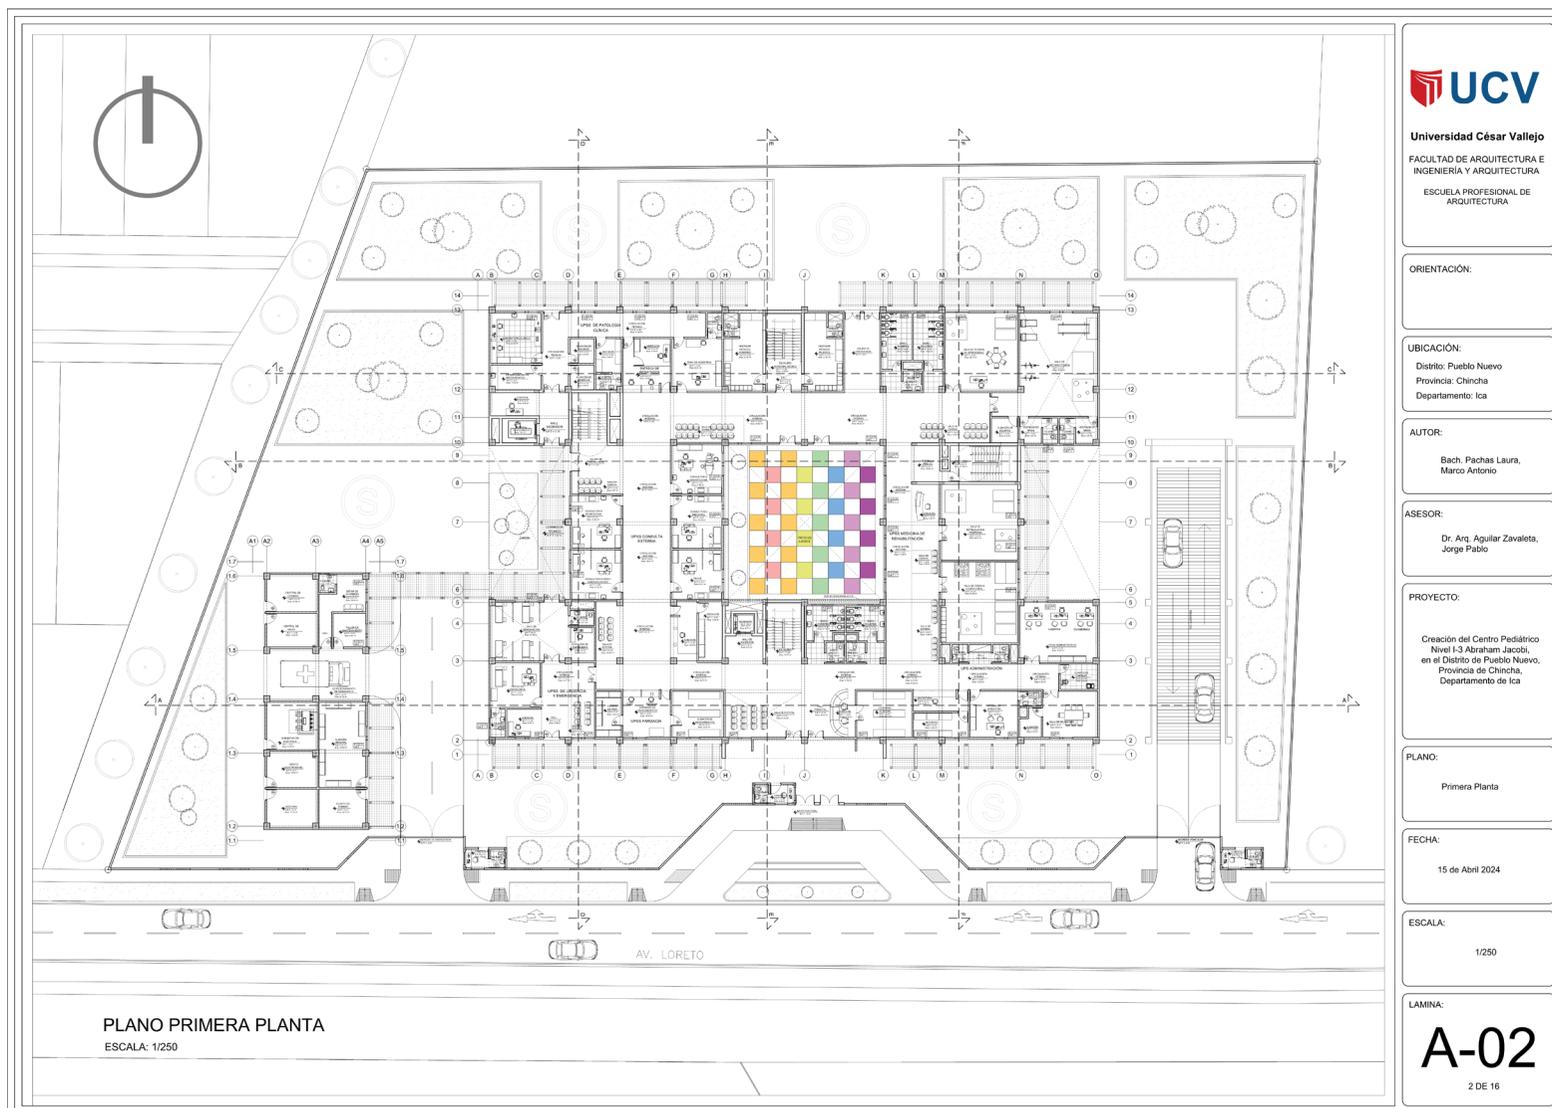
A-02 Plano primera planta. Fuente: Elaboración propia.
